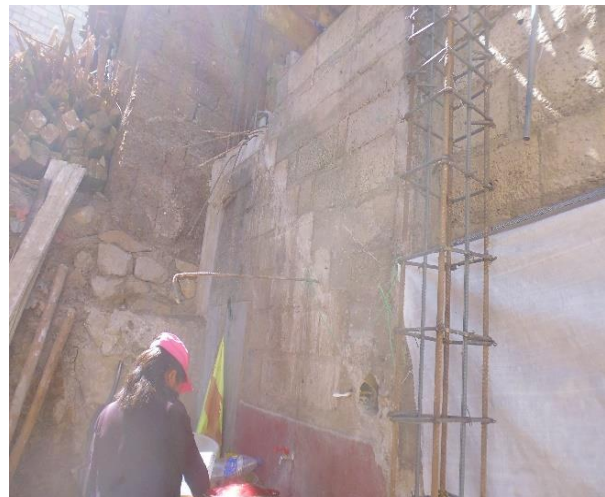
Se observa la fachada de la vivienda y el deterioro del muro.
